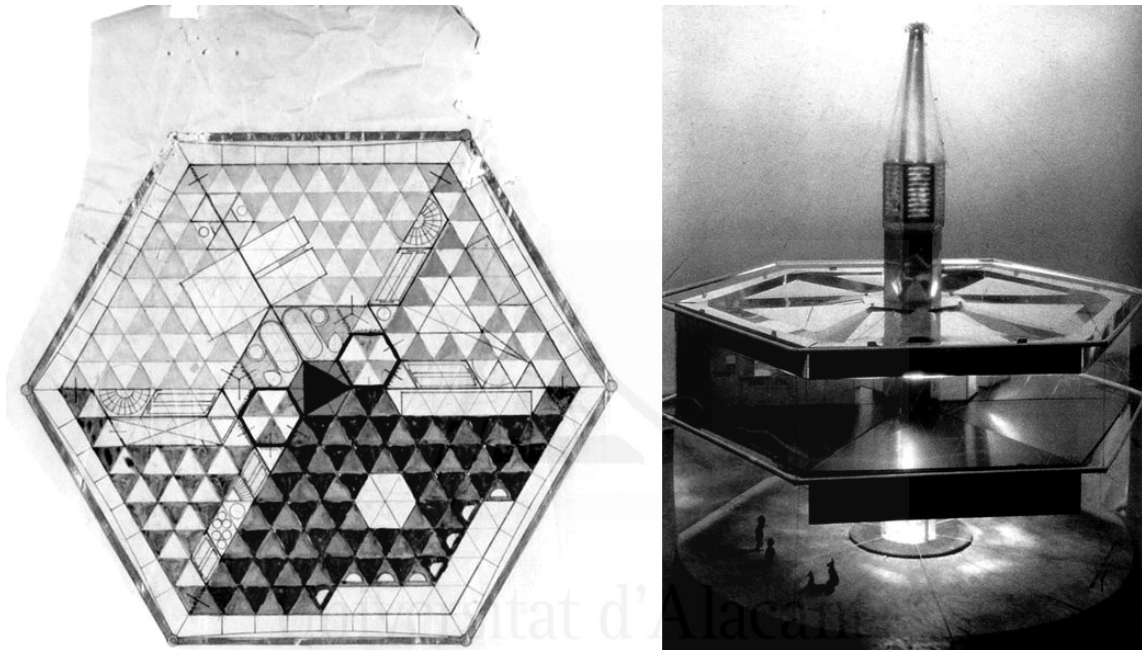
Planta y maqueta del proyecto Dymaxion House de 1927. Ilustración extraída de *"Prefab Houses"* (Cobbers et al., 2010, p.17).
